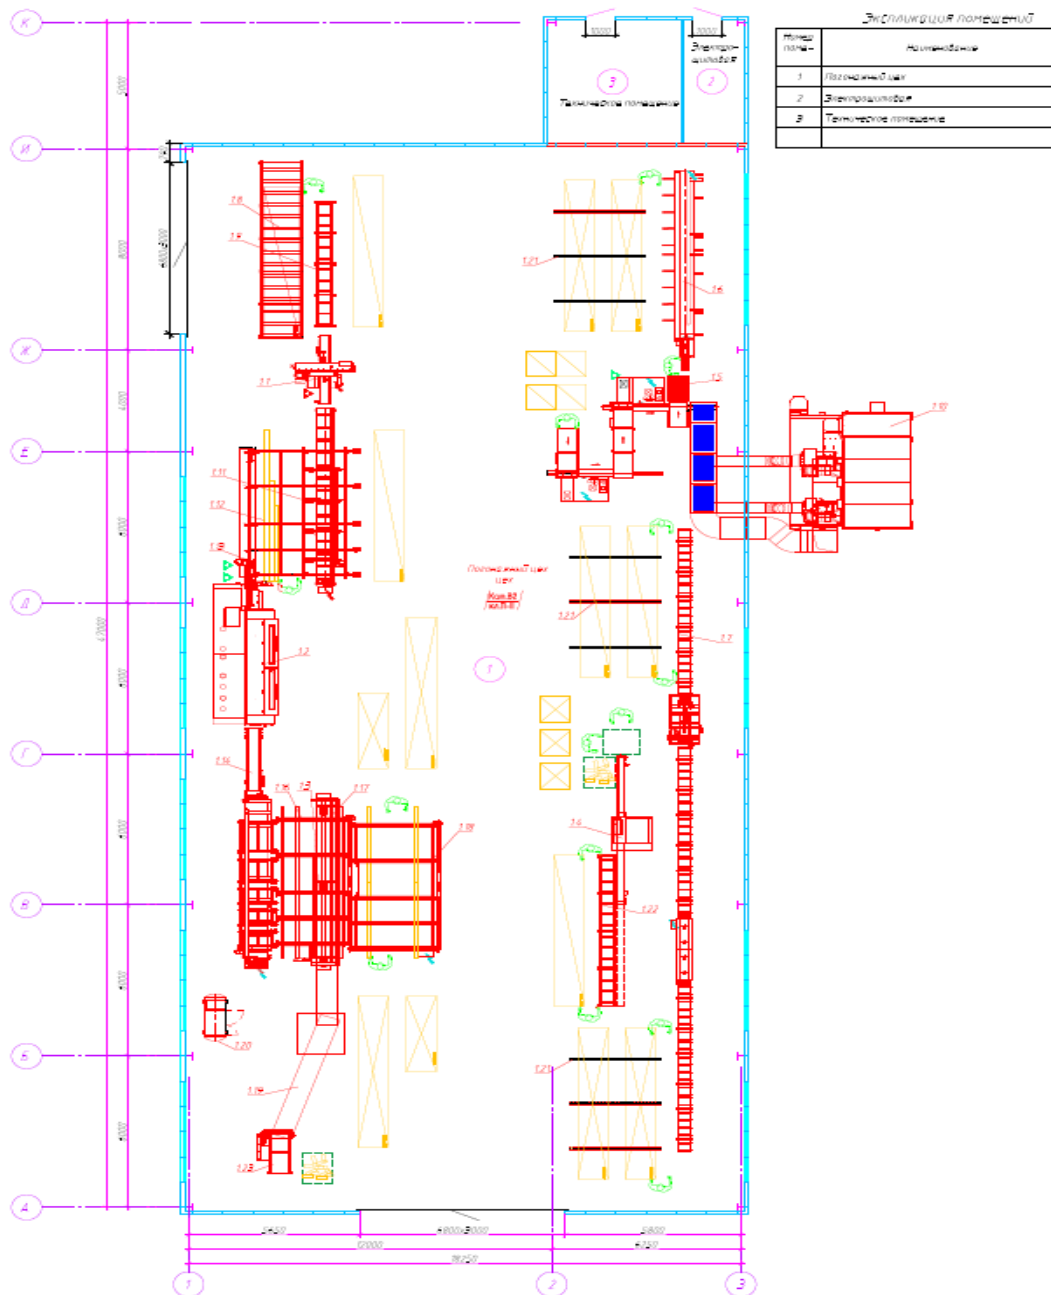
Планпогонажного цеха (по ГП №2)
